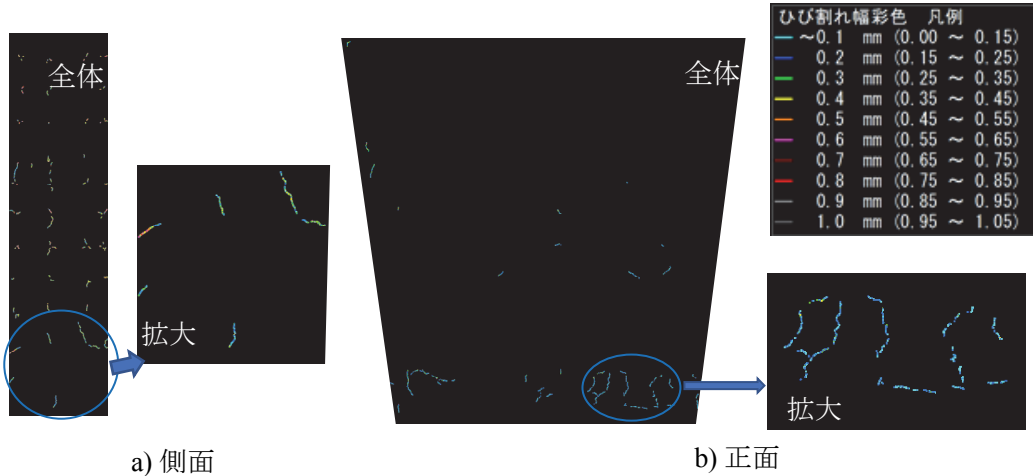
A大橋のP3橋脚起点側のひび割れ図
